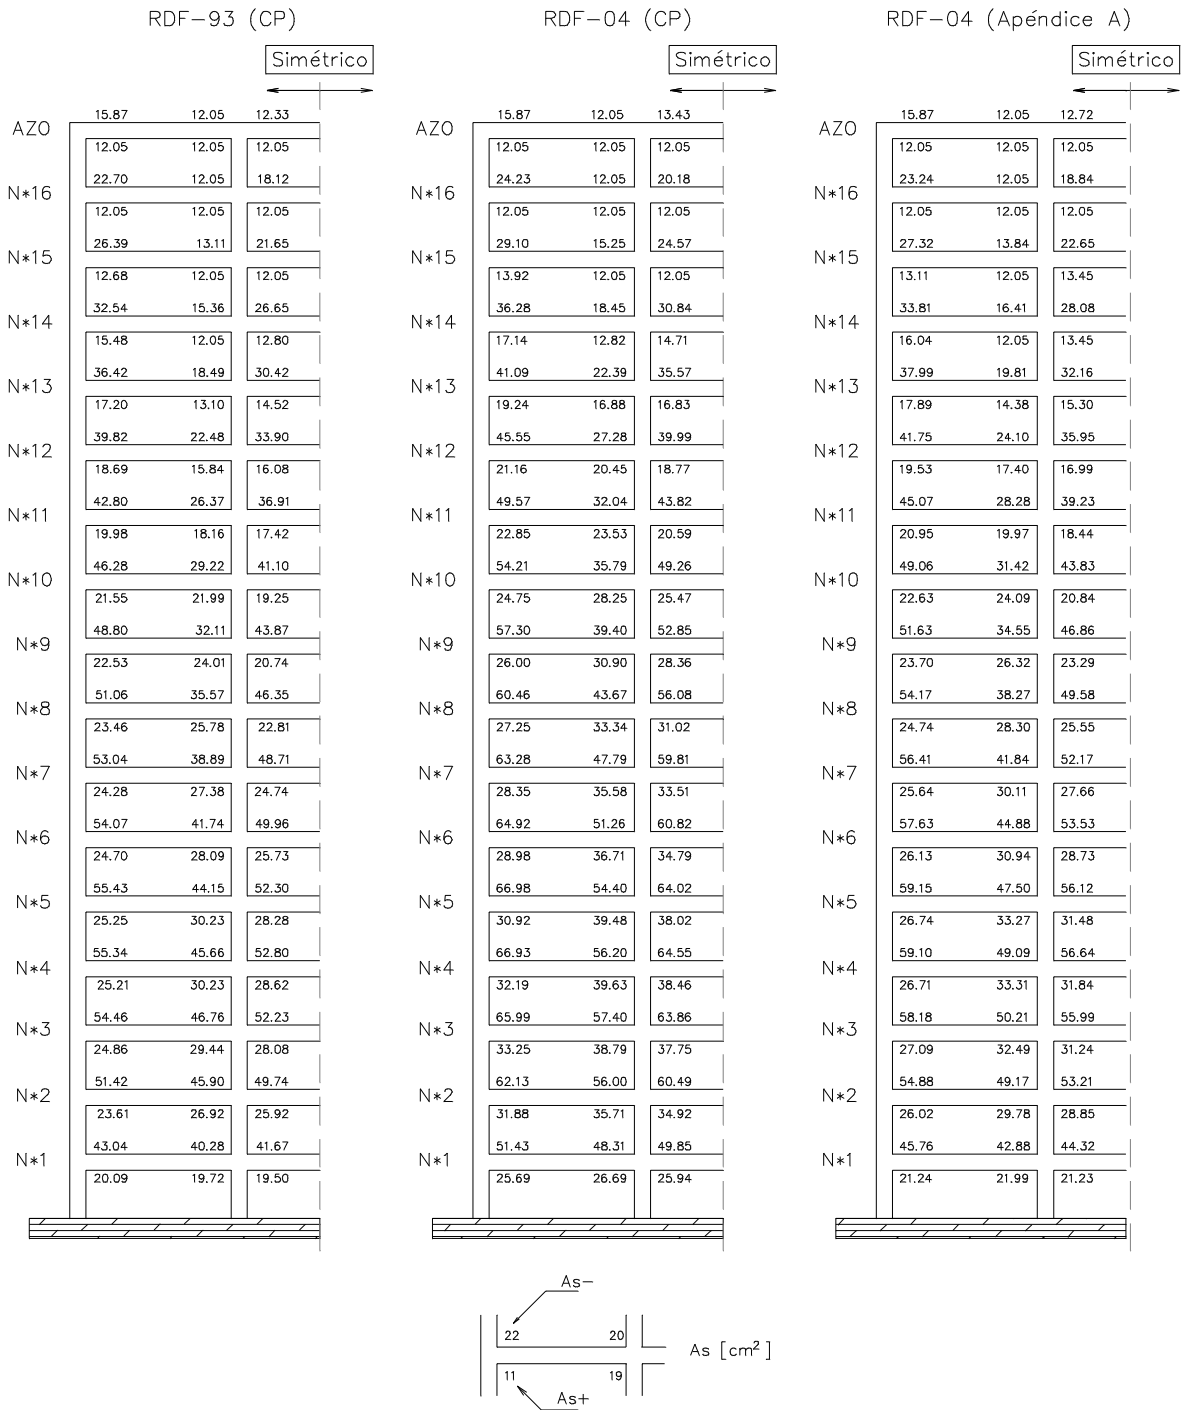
Comparación de áreas de acero de refuerzo longitudinal de los extremos de las vigas del eje 2 de las estructuras diseñadas en zona III (RDF-93 y RDF-04)
